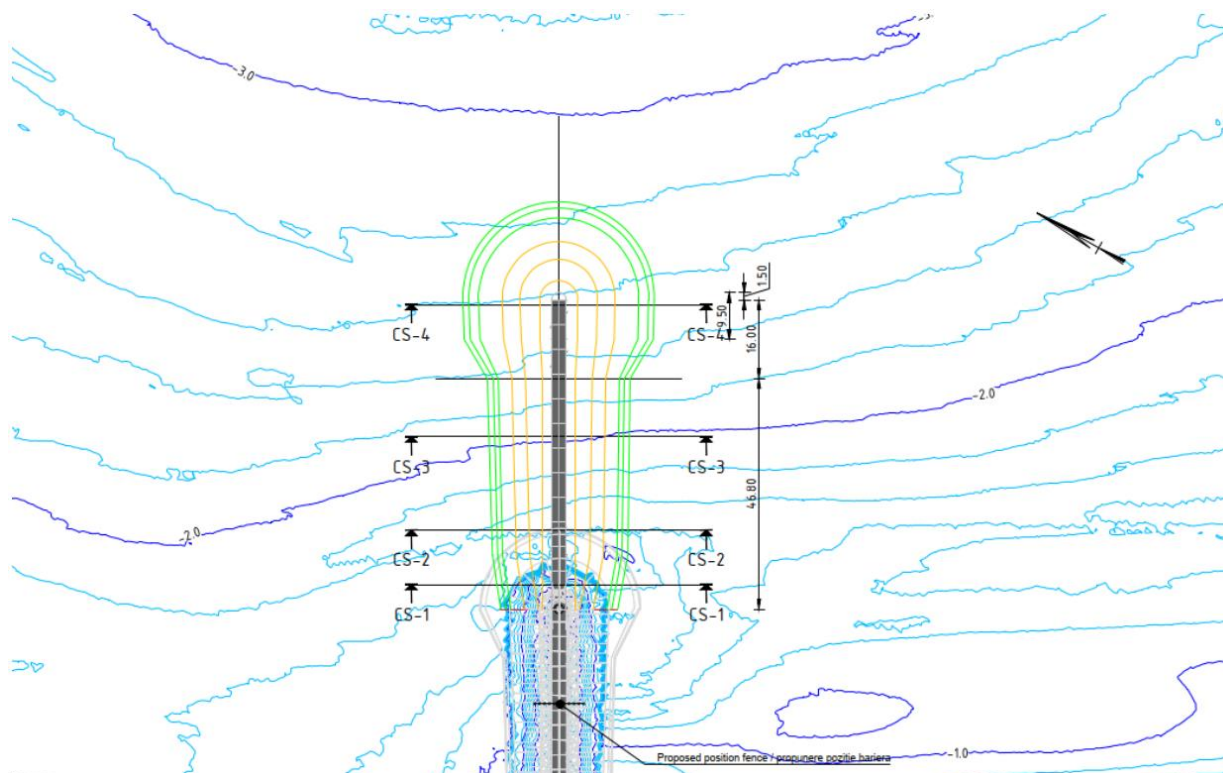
Vedere în plan a structurii costiere RJn1
